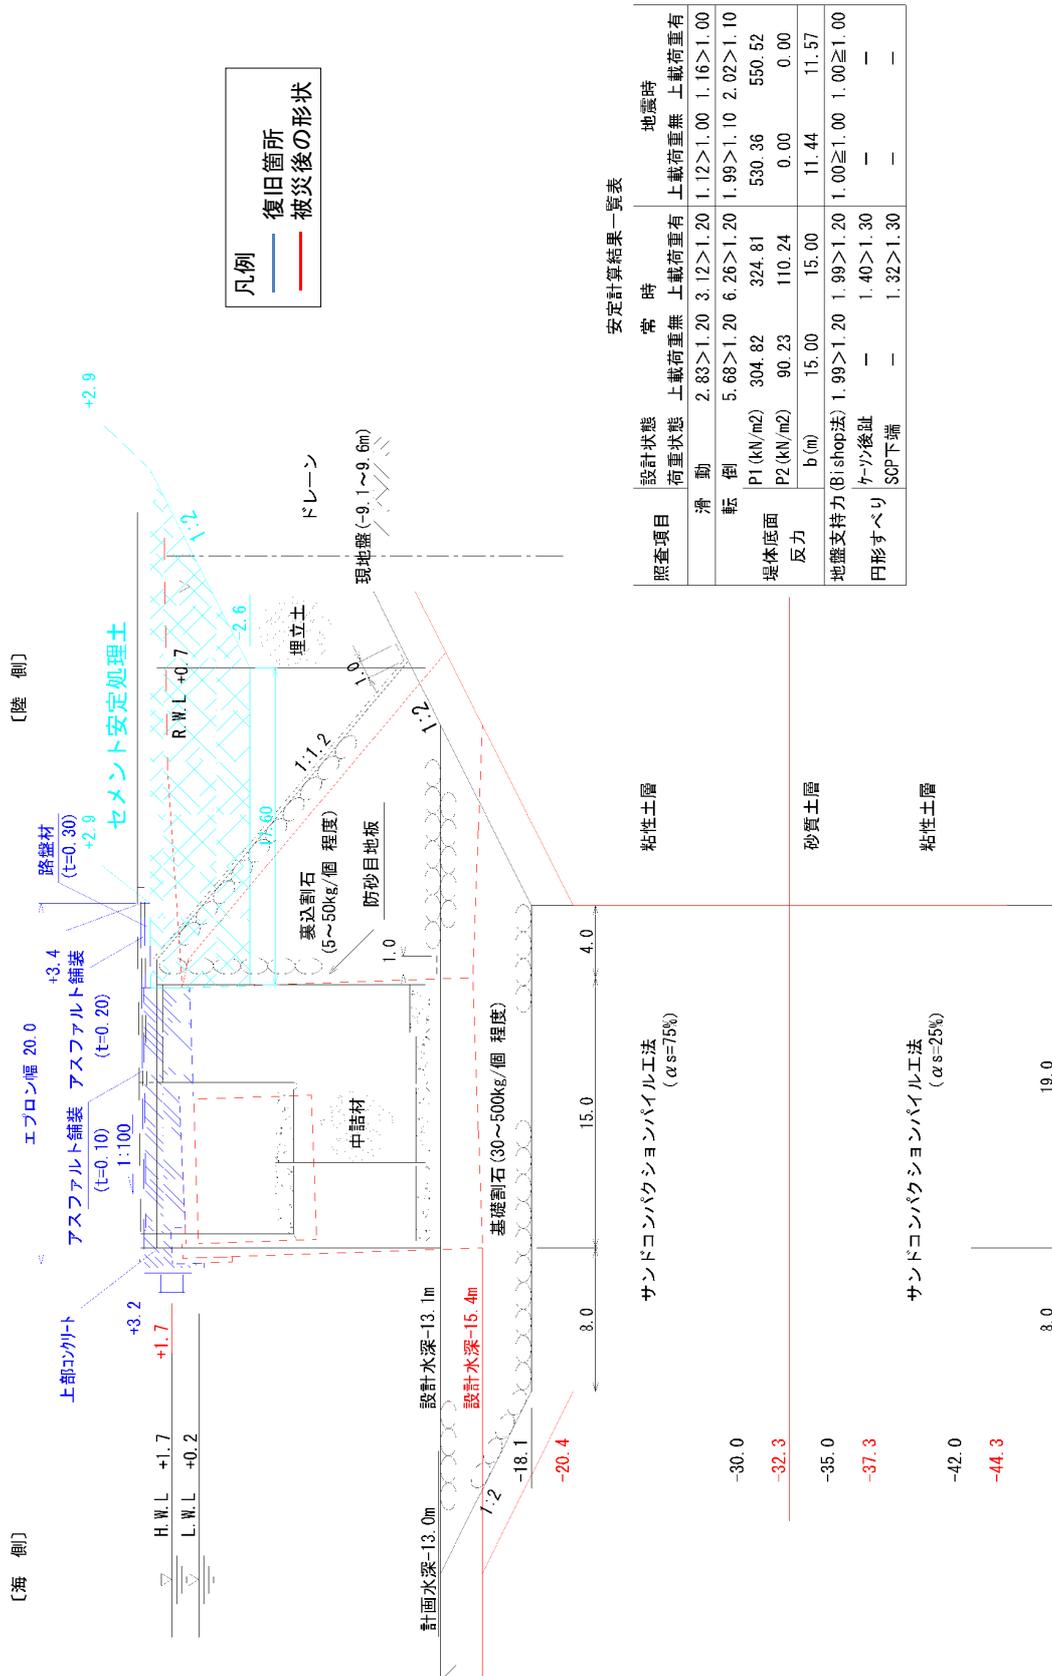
No.1 震雀野地区 岸壁(-13m)(1)の平面図 (被災後)
